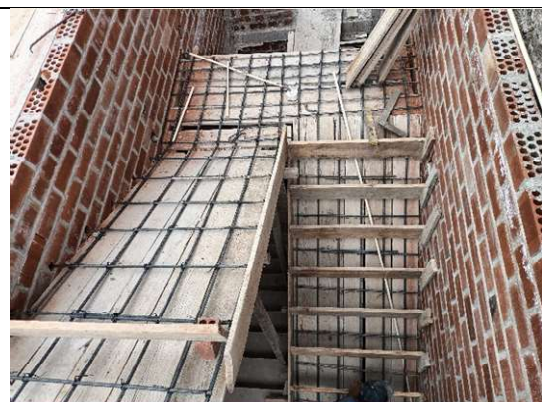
Vista de la escalera en forma de U construida en la vivienda 10
